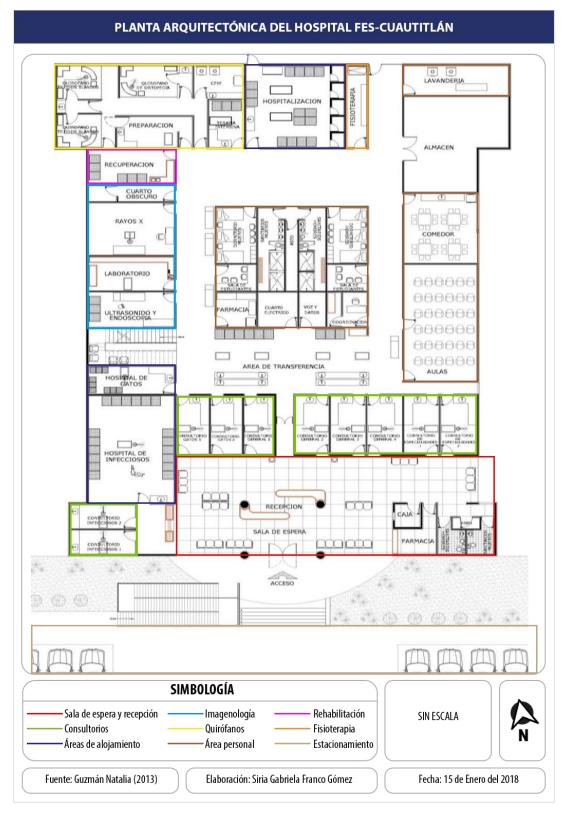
Planta arquitectónica nivel base de la facultad. Fuente: (Guzmán, 2013, pág. 16).
